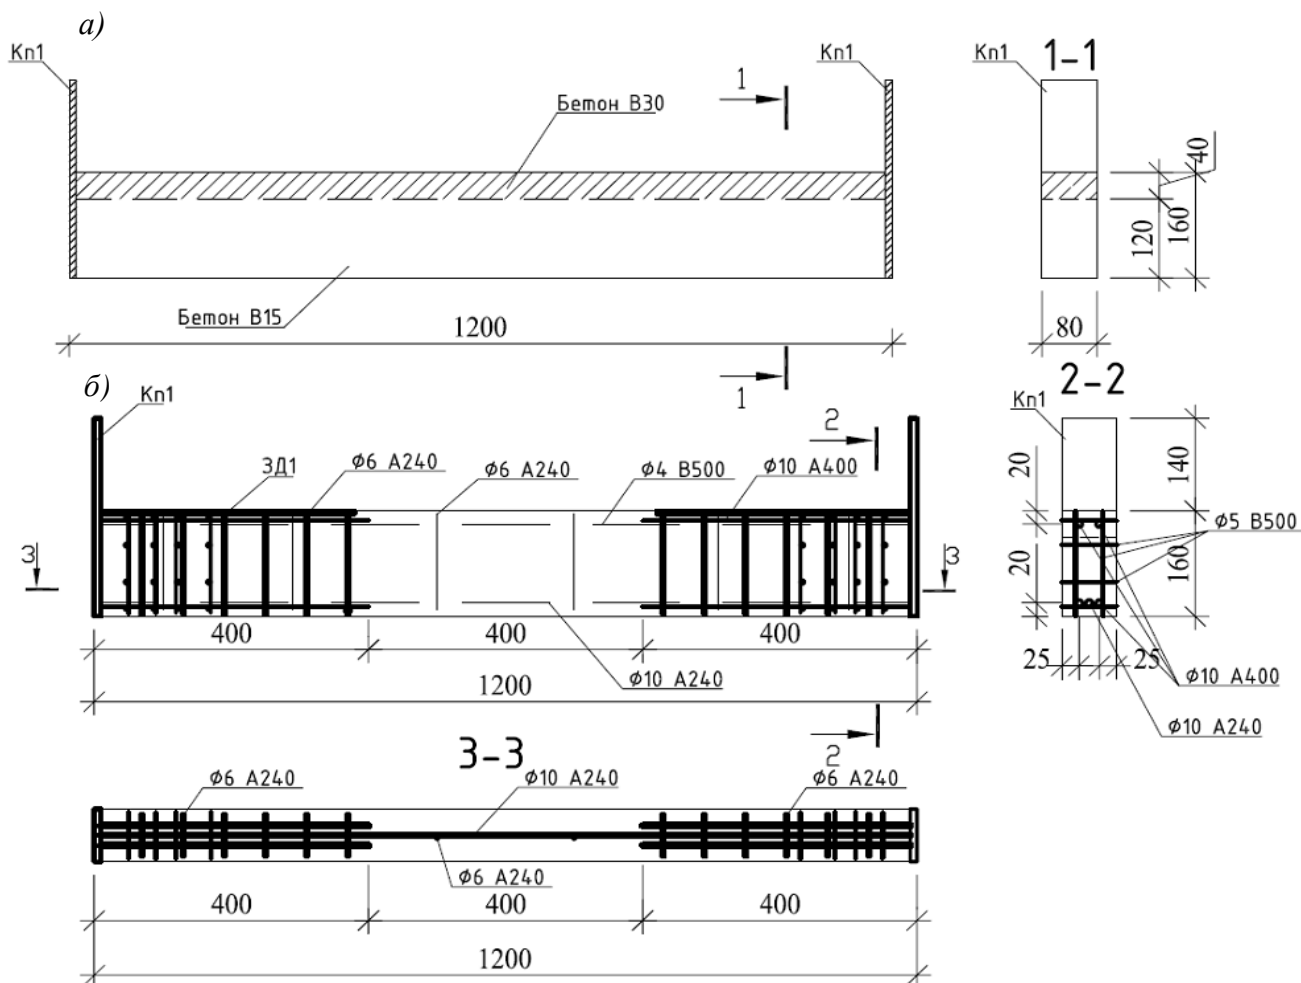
Схема армирования и поперечное сечение опытных образцов:
